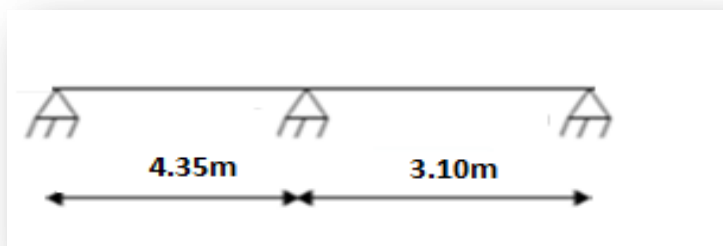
Schéma statique de la poutrelle à 2 travées
